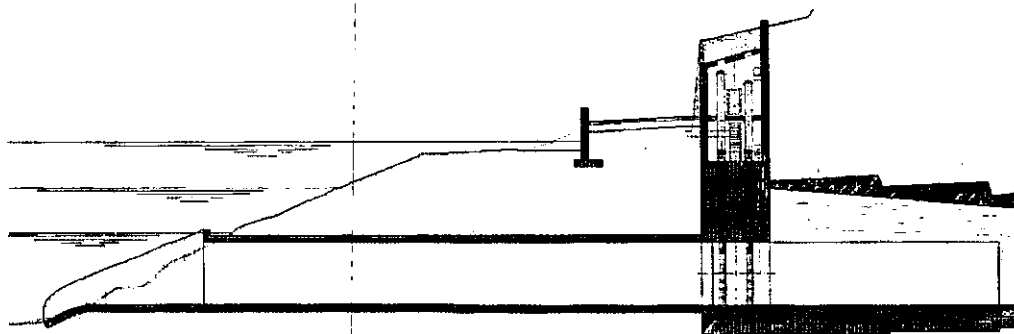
sezione imbocco galleria come previsto dal progetto preliminare.
